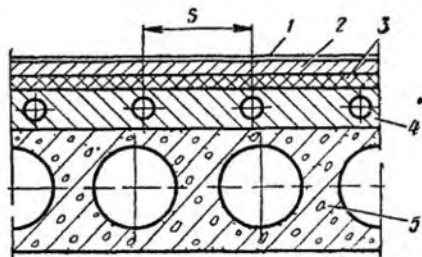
Размещение бетонной отопительной панели в перекрытии со сборным несущим настилом
